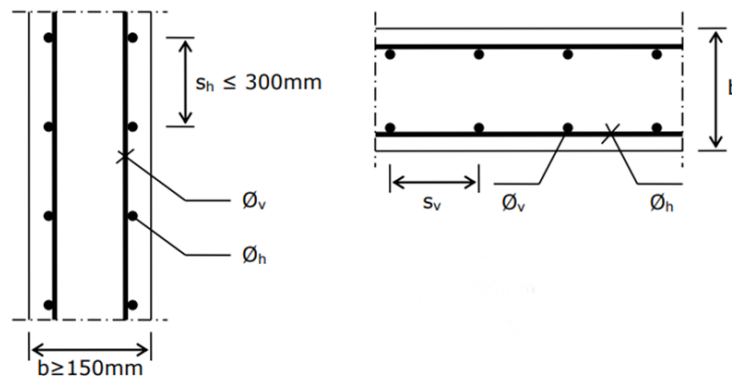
Corte vertical e horizontal da parede (Félix, et al., 2014)
